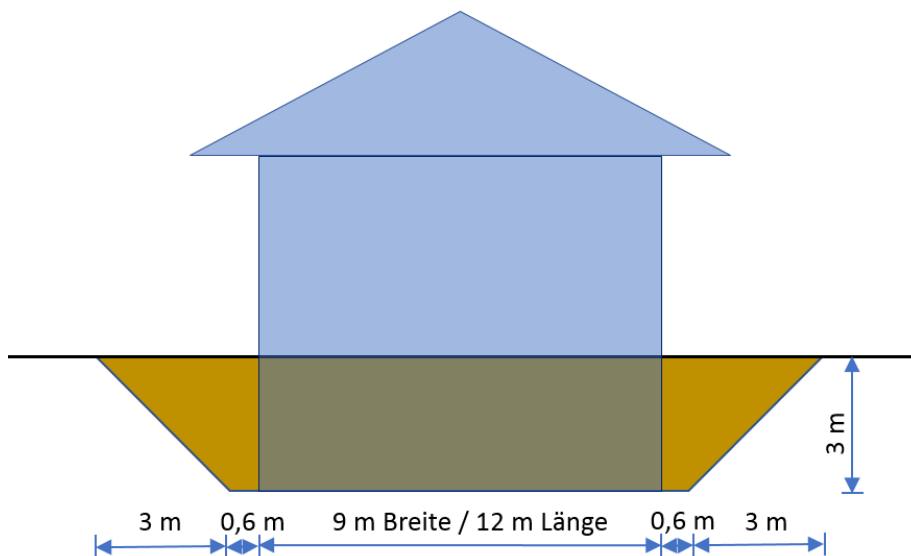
Baugrubenaushub eines Einfamilienhauses - Schnitt
